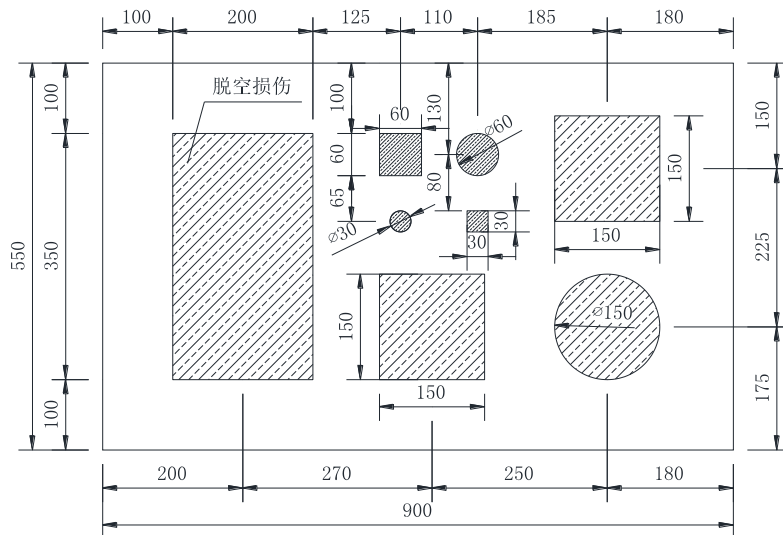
钢-混凝土组合板构件损伤位置与尺寸
